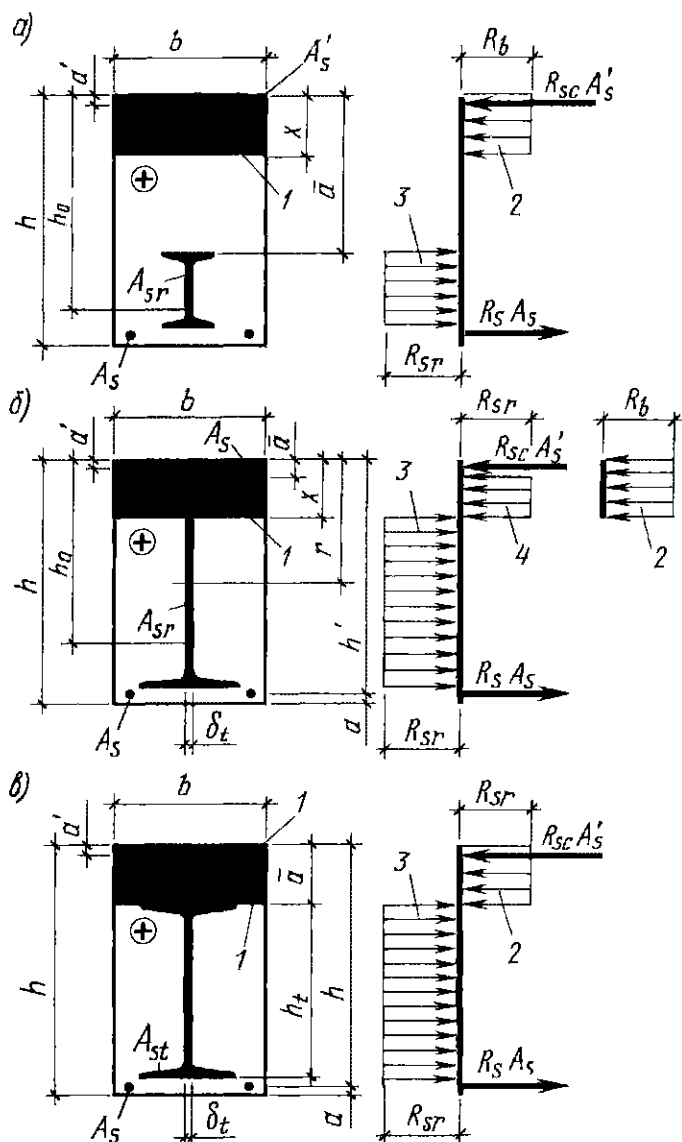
Случаи 1, 2, 3 (а, б, в) расположения нулевой линии для прямоугольного сечения: 1 — сжатая зона сечения; 2 — напряжения в бетоне сжатой зоны; 3 — напряжения растяжения в жесткой арматуре; 4 — напряжения сжатия в жесткой арматуре
